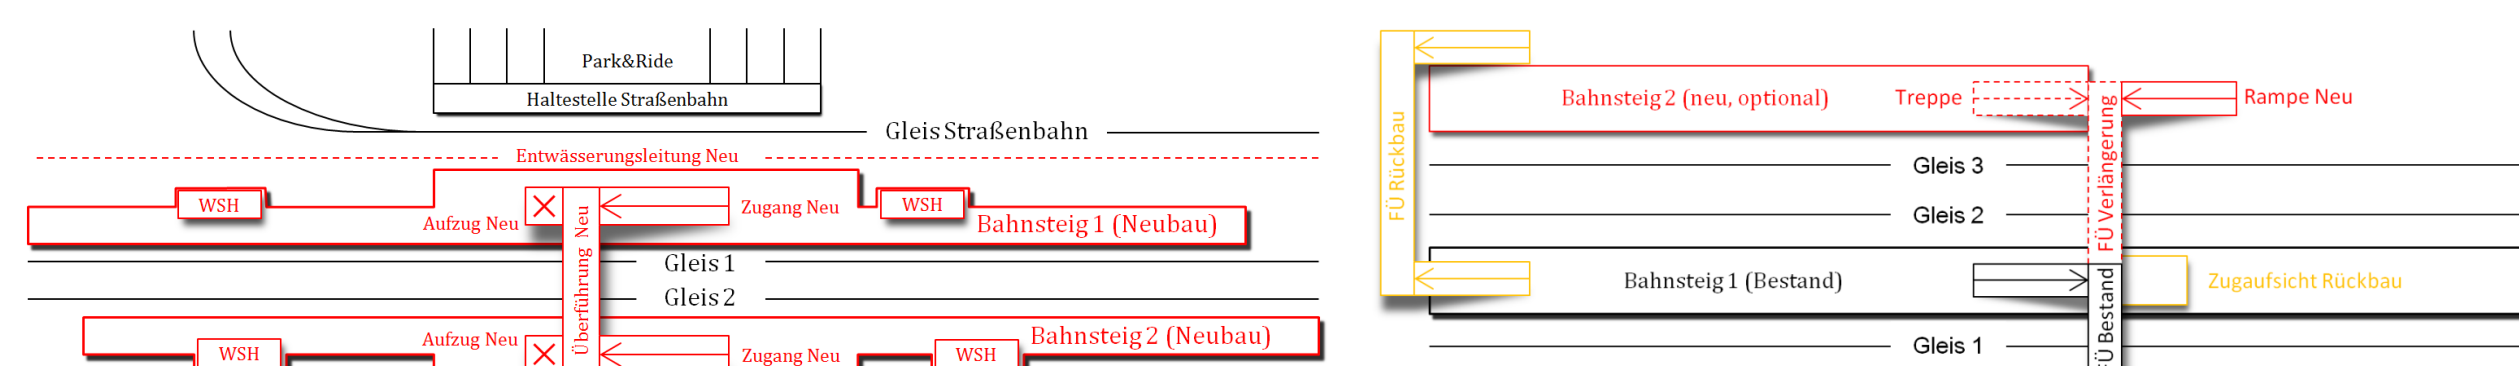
P1 – Neubau zweier Außenbahnsteige, P2 – Verlängerung Fußgängerüberführung als Anbindung an geplanten Mittelbahnsteig
